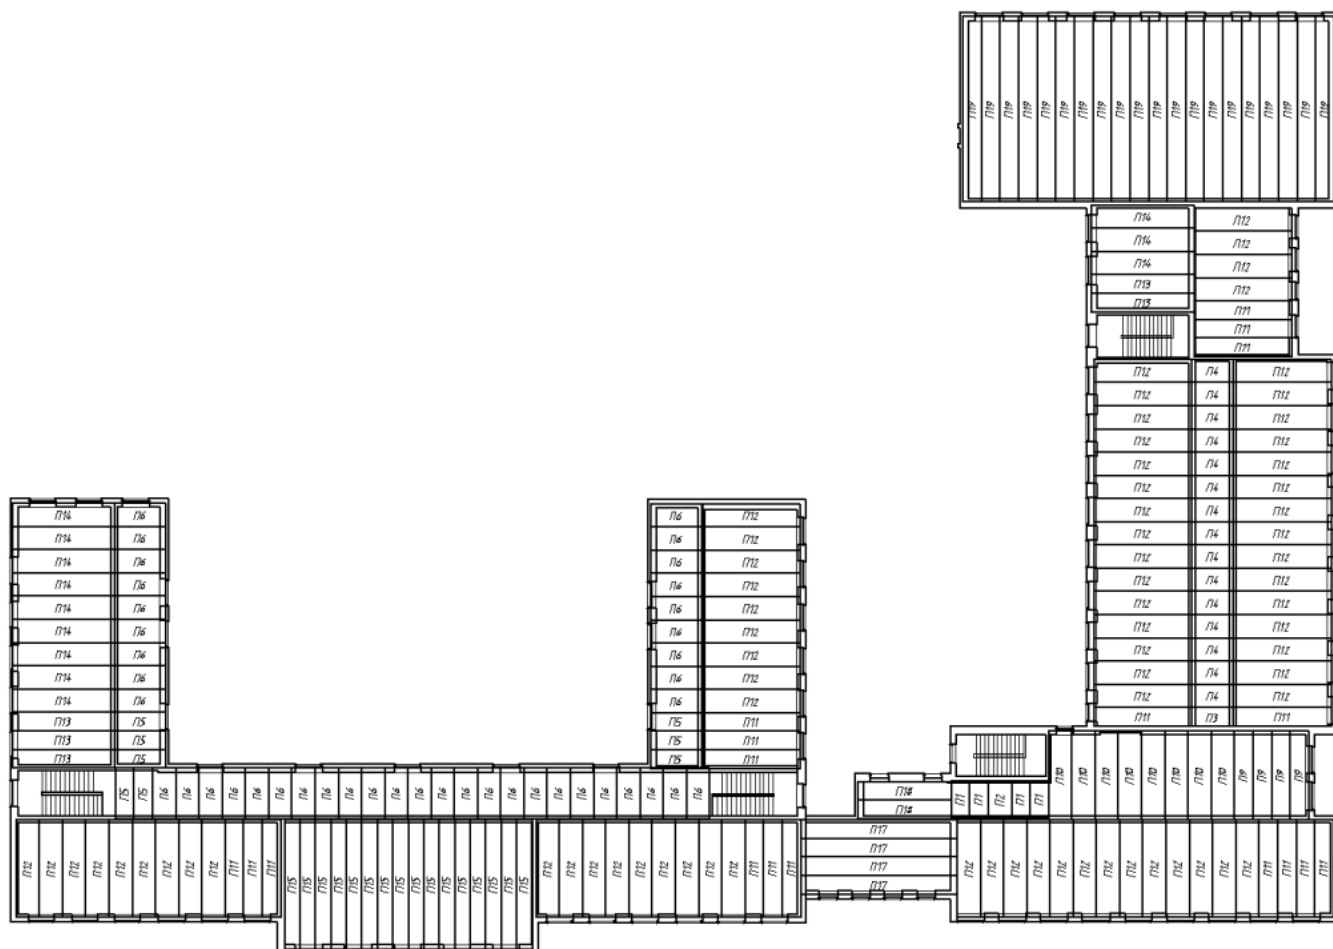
Схема розташування плит покриття 2-го поверху
